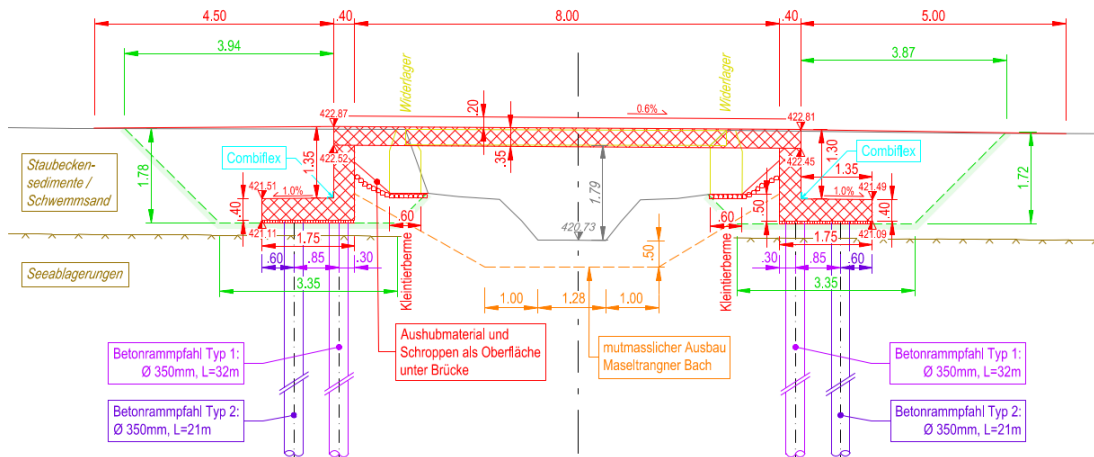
Ausschnitt Projektplan, Schnitt A-A
